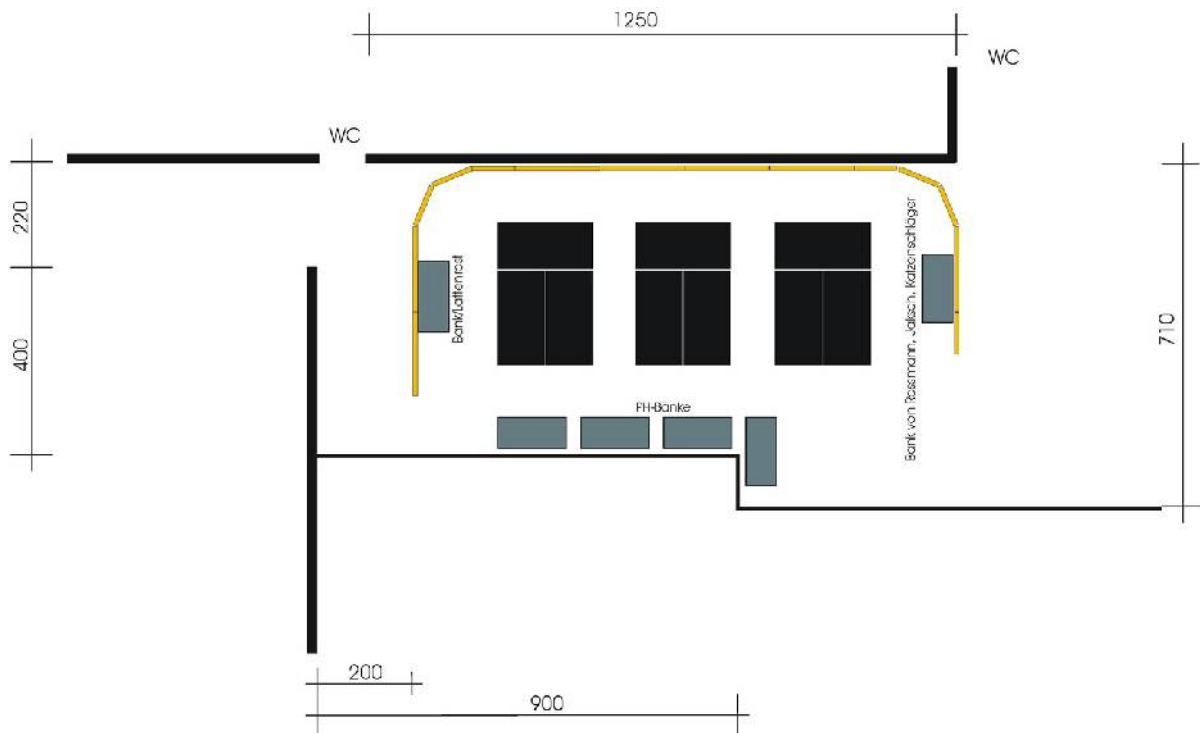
Grundrisskonzept für die Ausstellung, entwickelt im Maßstab 1:100 (Autor).
